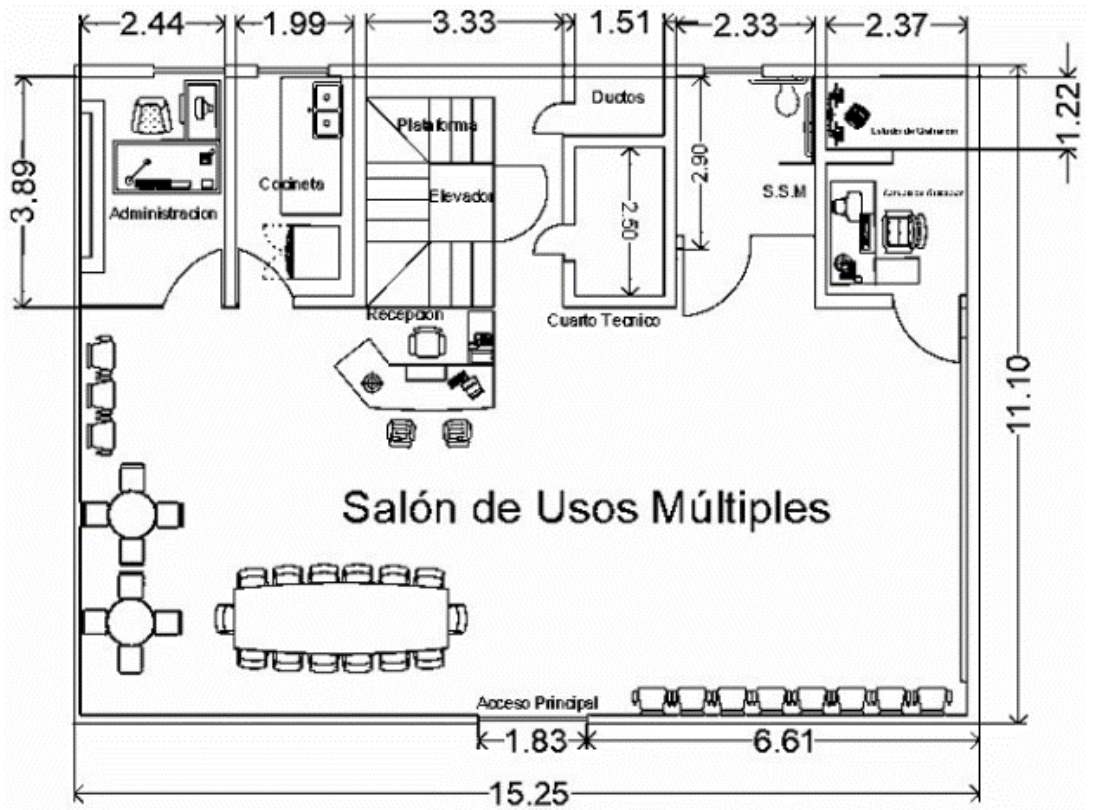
Plano arquitectónico del edificio CUBO El Tamarindo. Nota: Elaboración del autor en AutoCAD
